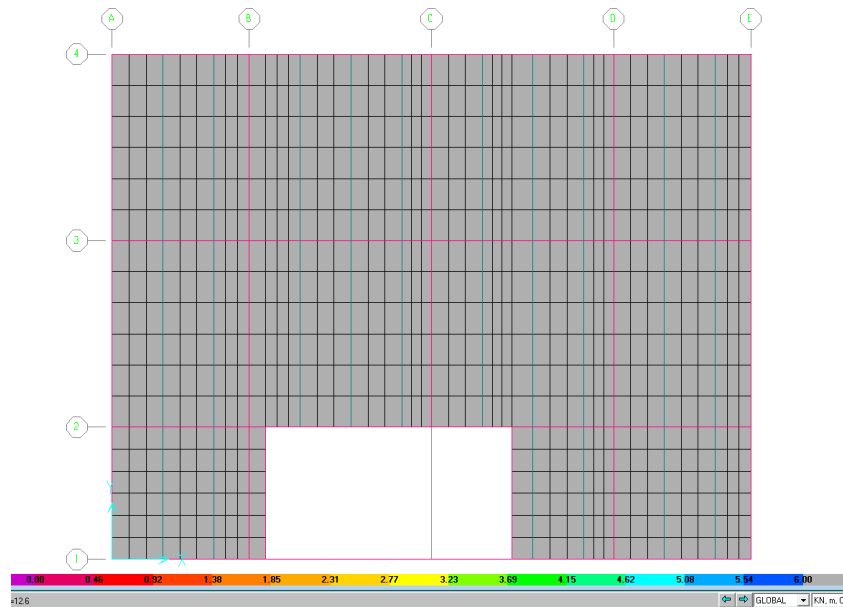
Planta nivel mezzanine módulo de acceso estación 19 costado sur oriental aplicación de la carga viva (6,0 kN/m<sup>2</sup>)
